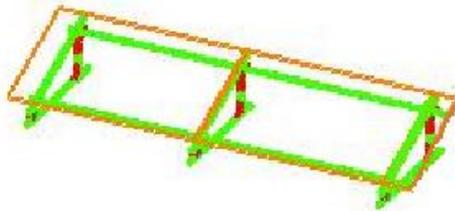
Detalle de la estructura soporte de las placas solares fotovoltaicas
